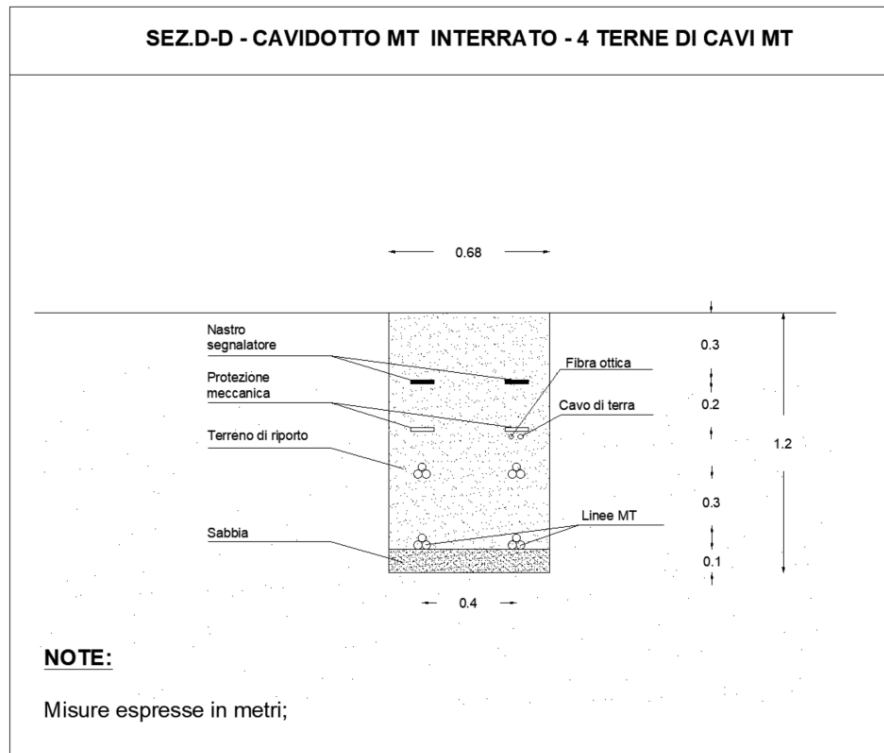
Stralcio elaborato “CEN.ENG.TAV.028 _Planimetria dei cavidotti con indicazione delle sezioni di posa” – Sezioni per interrimento del cavidotto MT
